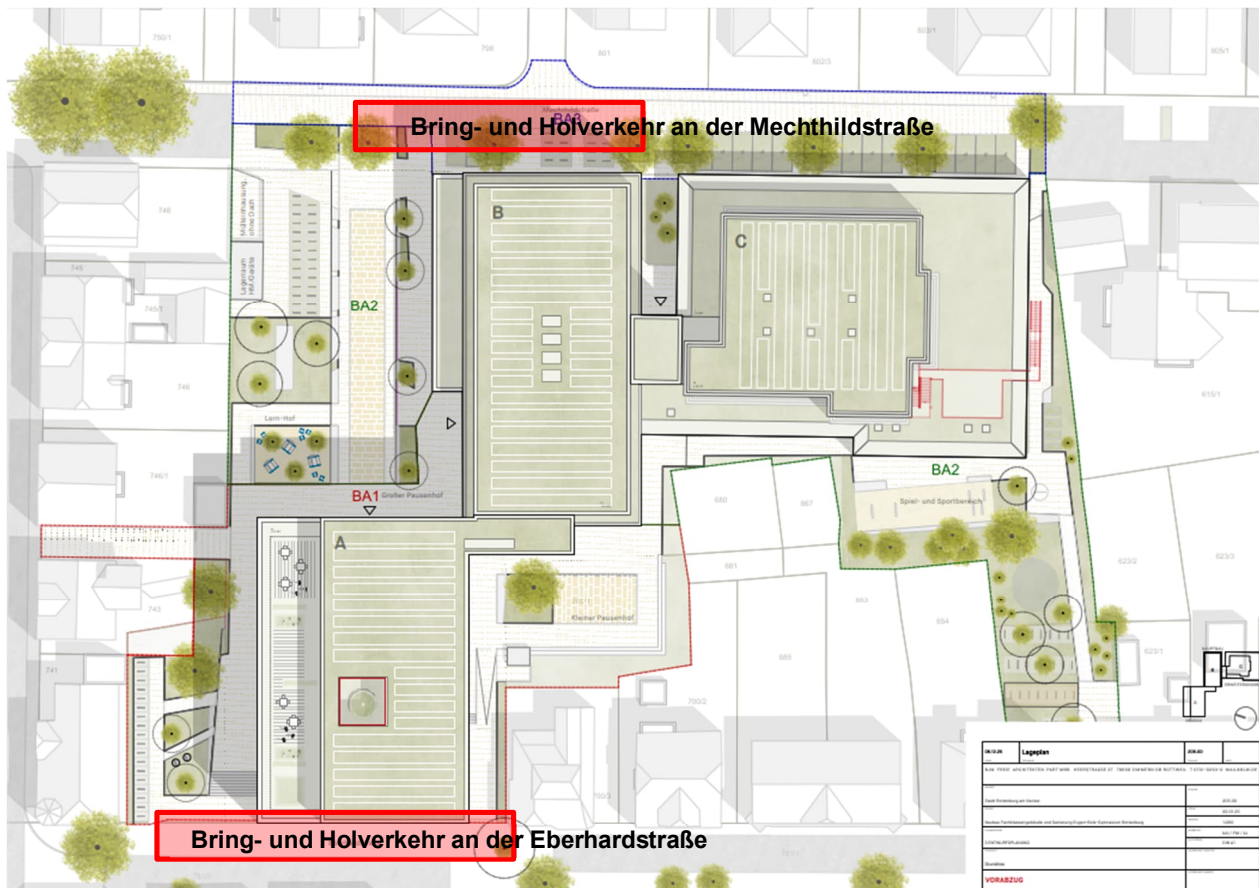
Lageplan mit Kennzeichnung des Bring- und Holverkehrs
